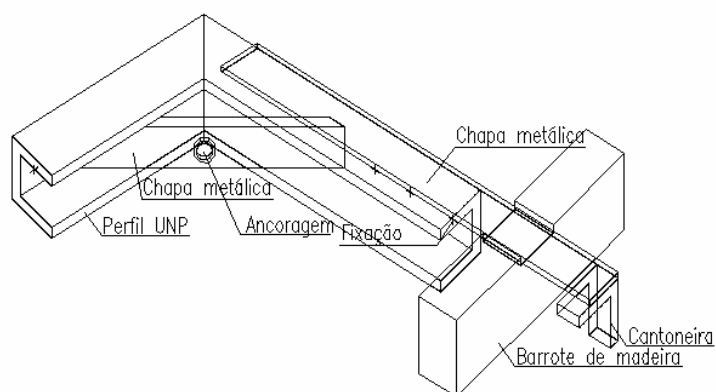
Pormenor de ligação nos cantos das divisões.
